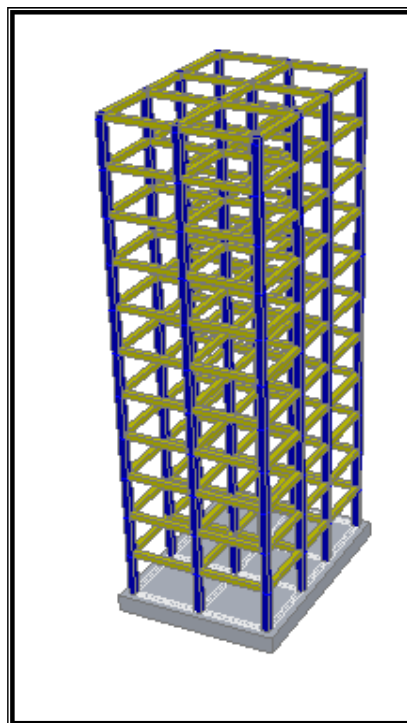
Vista 3d de la superestructura con la cimentación superficial
